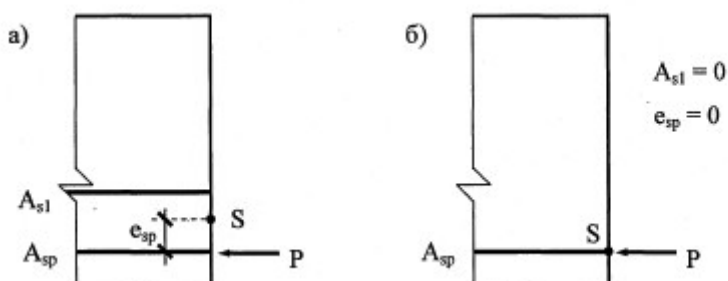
а) конструкция с двухрядным расположением арматуры,
